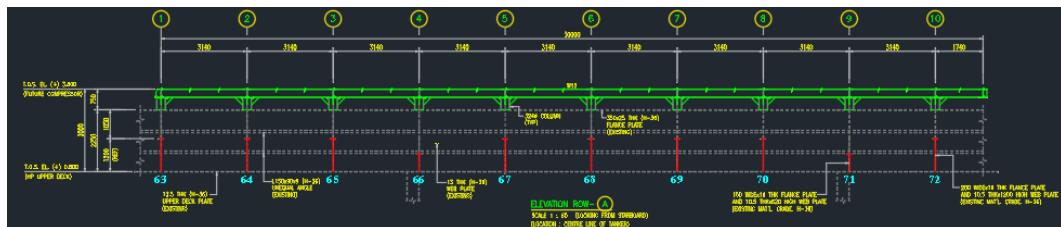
Elevation Rows 4, 9 (Section Melintang di fr. 66 dan fr. 71)
